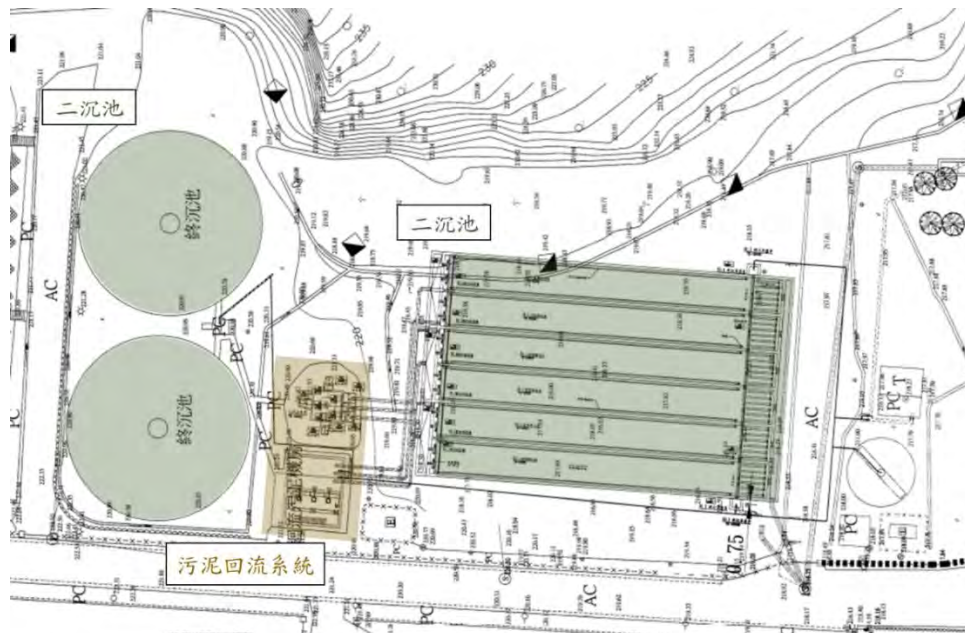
龜山水資源回收中心平面圖(2/3)
